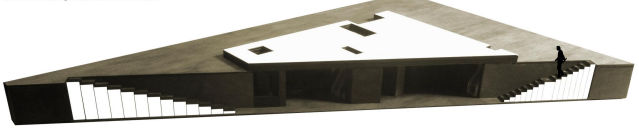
FOTO DE LA MAQUETA. ACCIONAMIENTO DEL CIERRE
